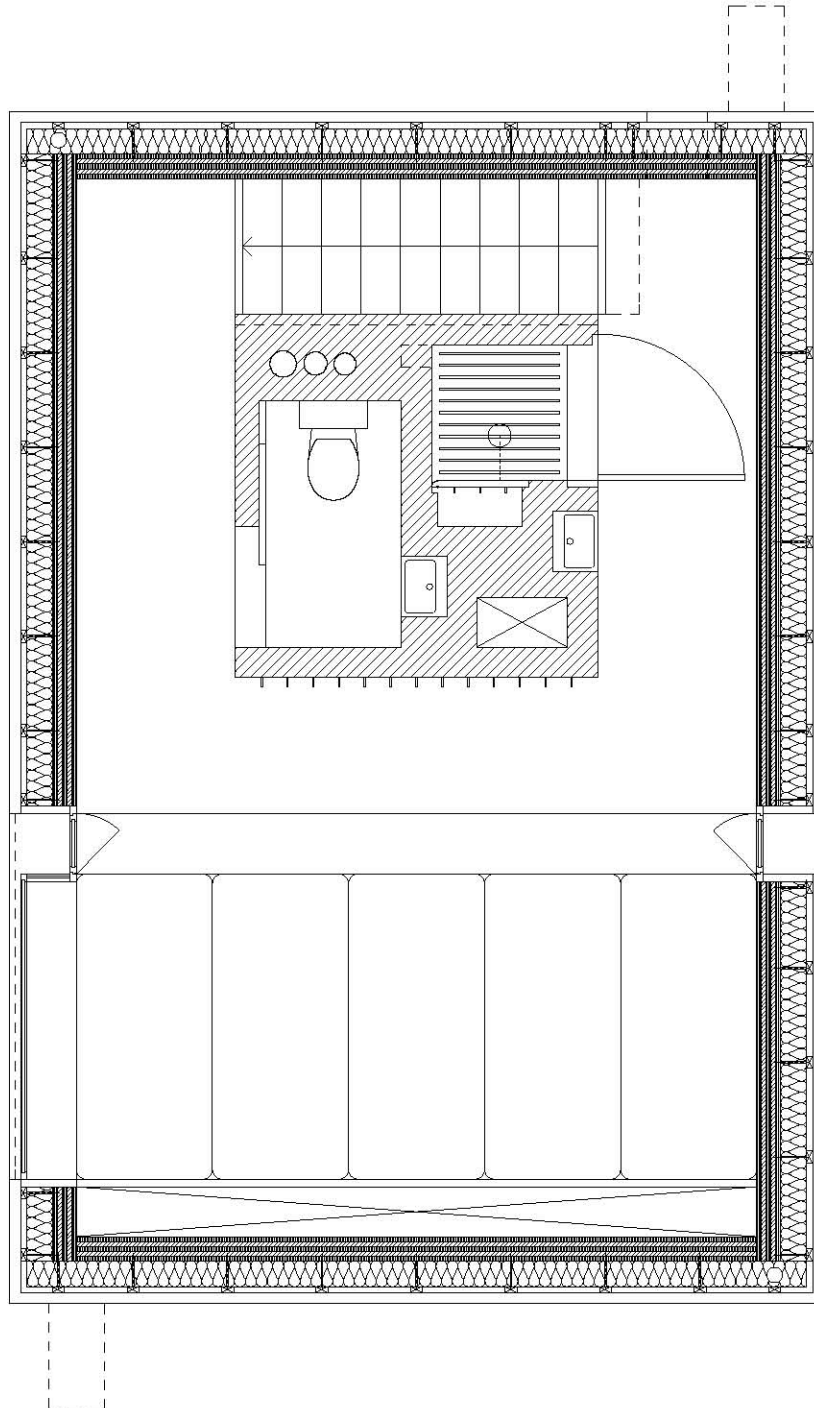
SISTEMA MACIÇO, PLANTA PISO 1, ESCALA 1:50.
